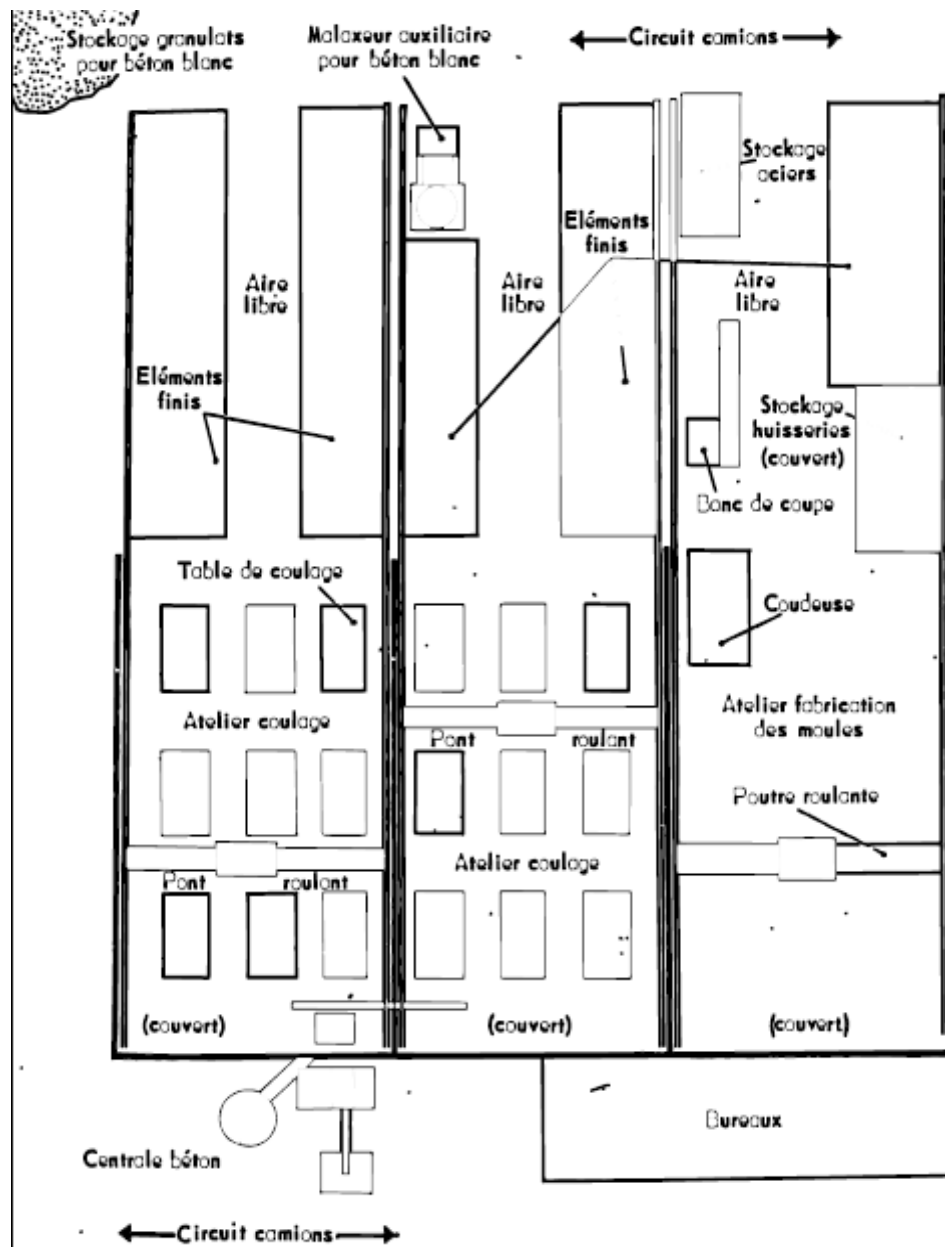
exemple de plan d'aménagement d'un atelier préfabrication
